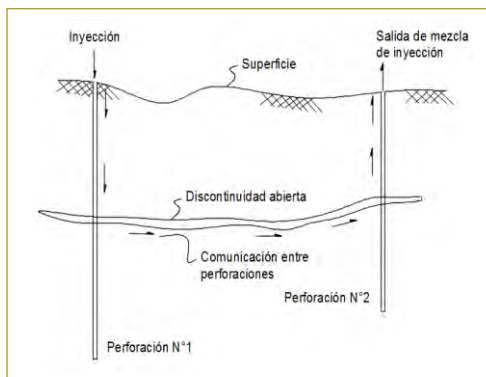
Representación esquemática de una conexión de mezcla entre perforaciones. Adaptado de Dam foundation grouting, Kenneth D. Weave & D.A. Bruce (2007).
